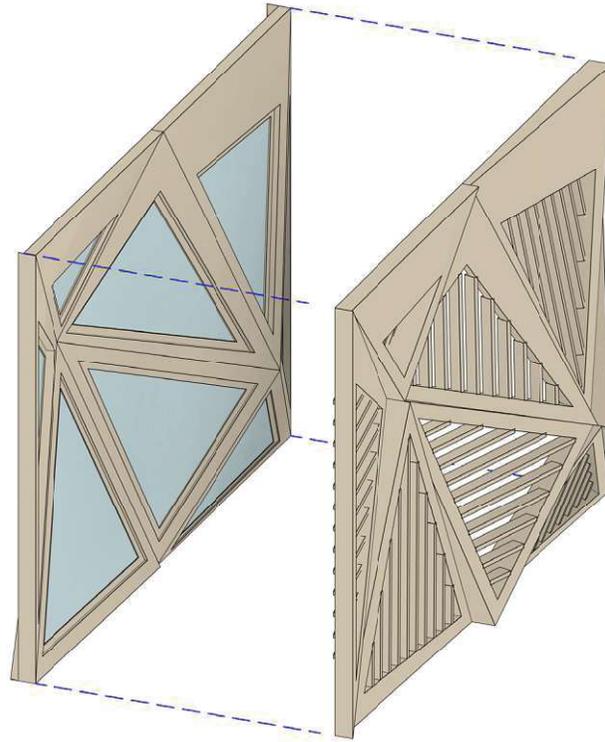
Fassadenstruktur. Innere Schicht: Fenster, Äußere Schicht: Tragkonstruktion and Schattung
